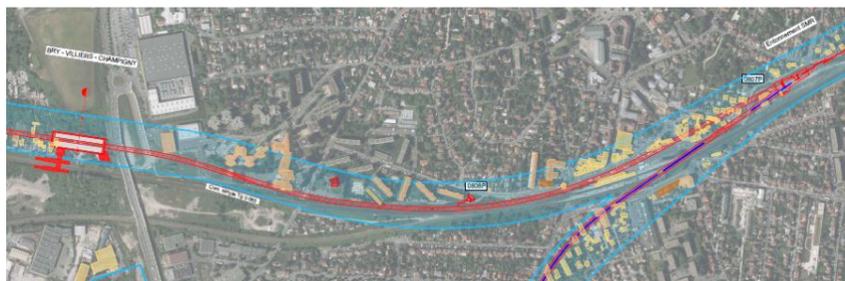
Tracé en plan BVC/Ouvrage débranchement SMR, 1/2
